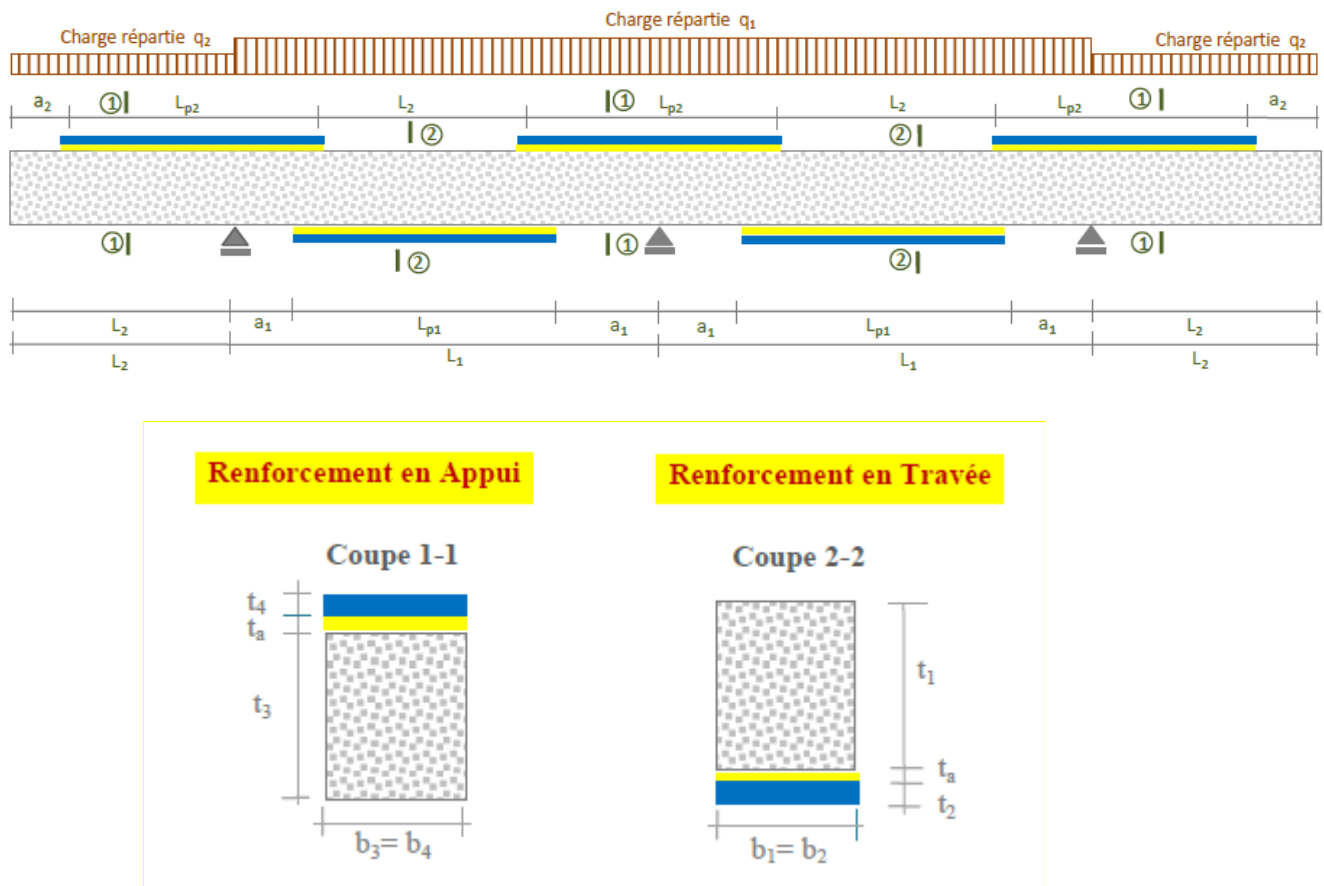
Poutre continue en béton armé renforcée par collage des plaques en composite.
